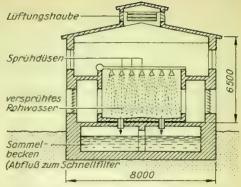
Verdüsungsanlage (Belüftungsanlage)
